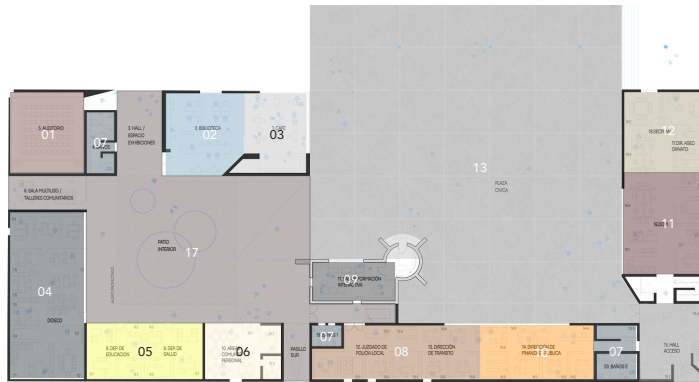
Distribución de áreas planta baja edificio consorsial de Papudo (2015). Fuente: Archdaily Elaborado por el autor
